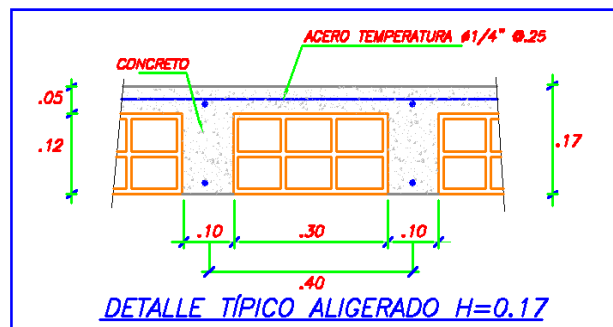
a: Sección de Losa Aligerada con Viguetas Convencionales
